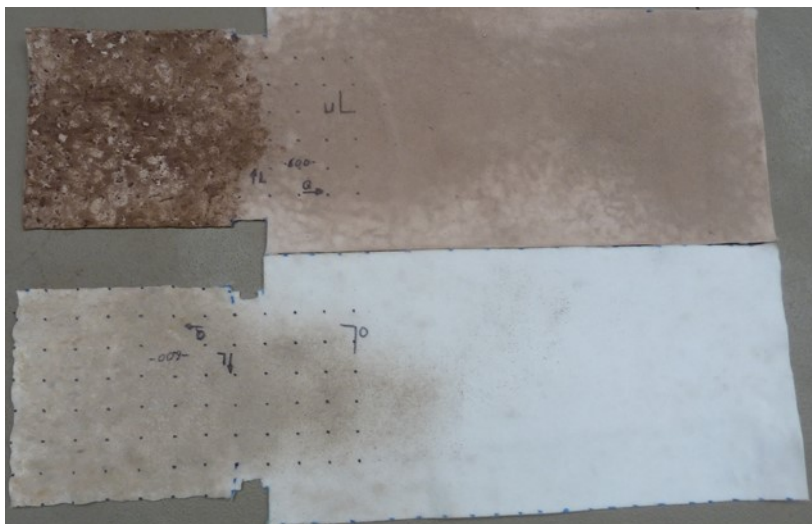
Rückbau modifizierter Kompressionsversuch 2017/10/18 (oben: untere Lage unten: obere Lage; jeweils 600 g/m²)
